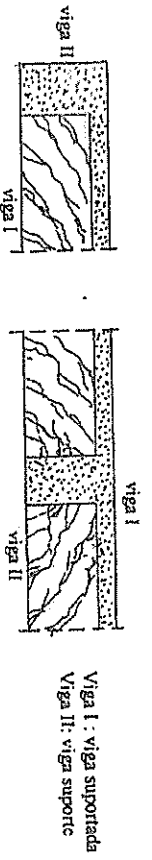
Panoramas de fissuração de viga carregada indiretamente e de viga apoia indiretamente
